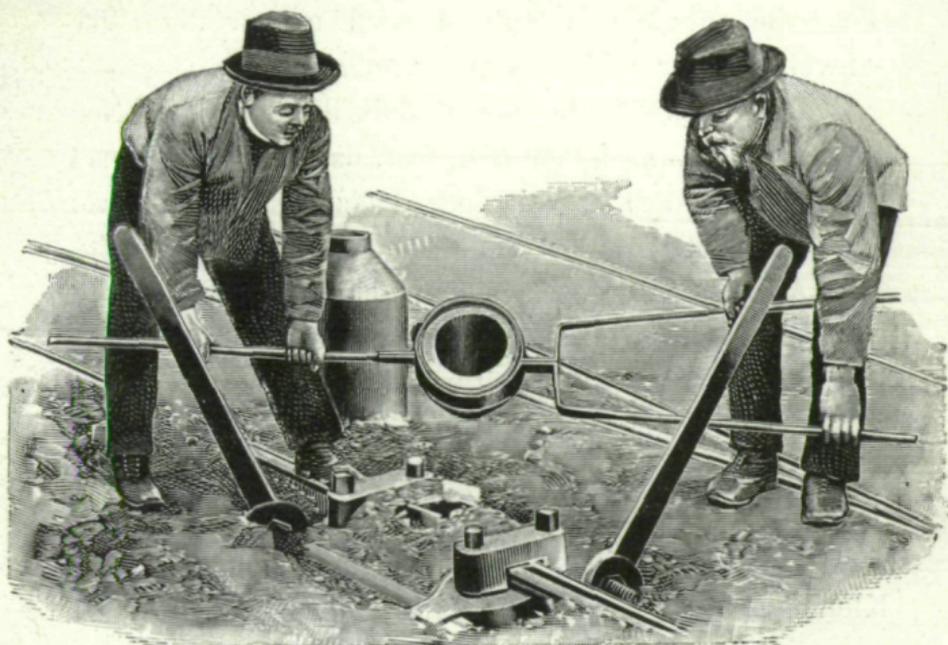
Schienenschweißung auf der Strecke.
